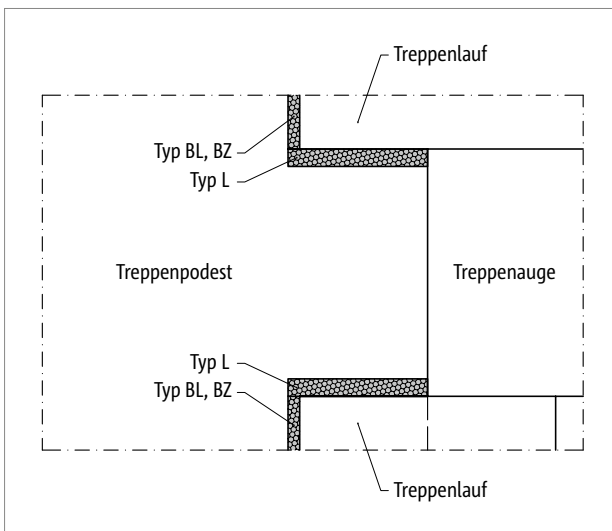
Schöck Tronsole® Typ BL, BZ: Elementanordnung, Detail A
